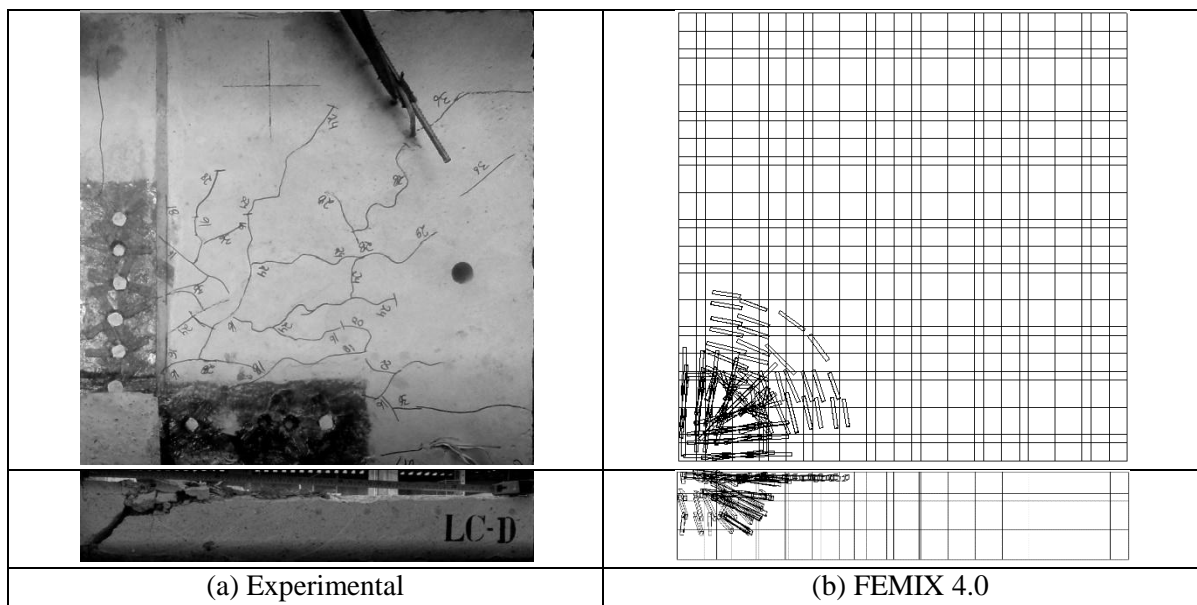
Padrão de fissuração - LC-D (FEMIX 4.0)
